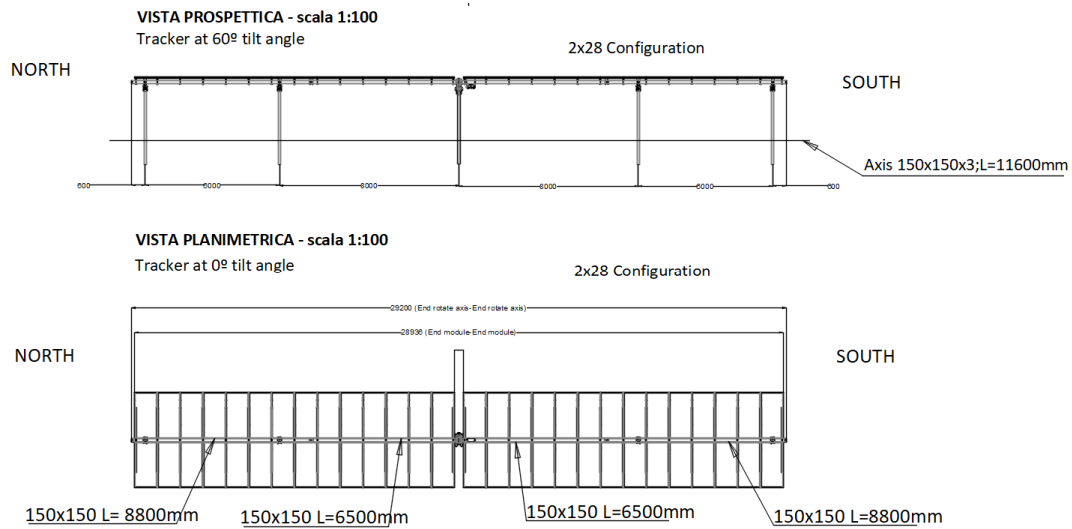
Vista prospettica e planimetrica delle strutture porta-moduli tracker 2x28
